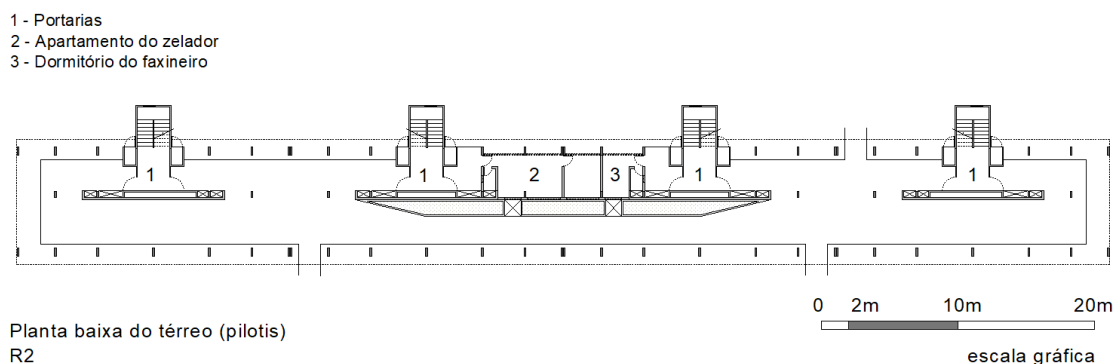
Planta baixa do térreo (pilotis) do R2. Fonte: da autora, adaptado das pranchas originais do Acervo do Arquiteto Milton Ramos.
